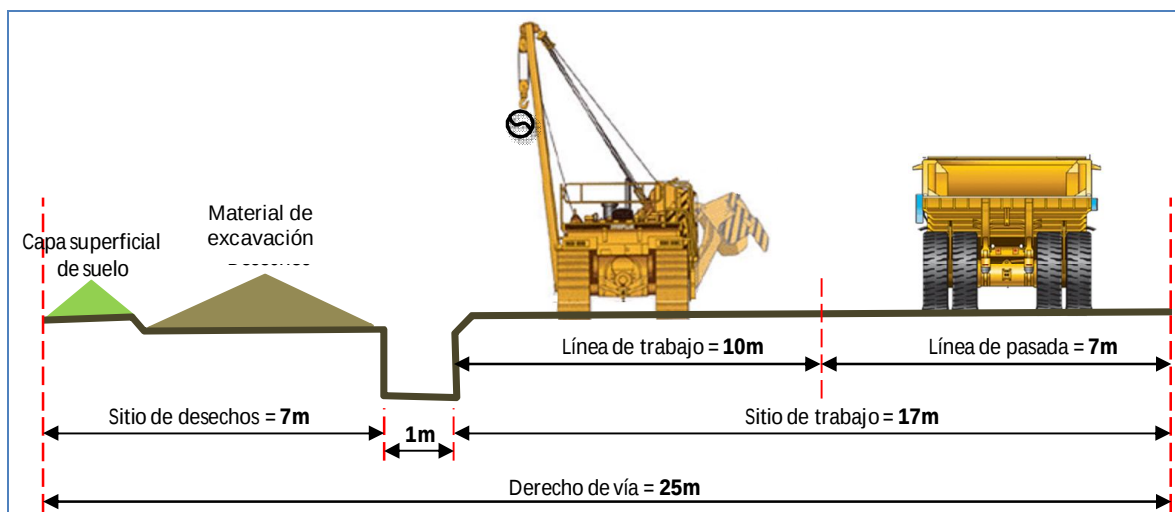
Imagen típica de la apertura del DDV en zona plana.
